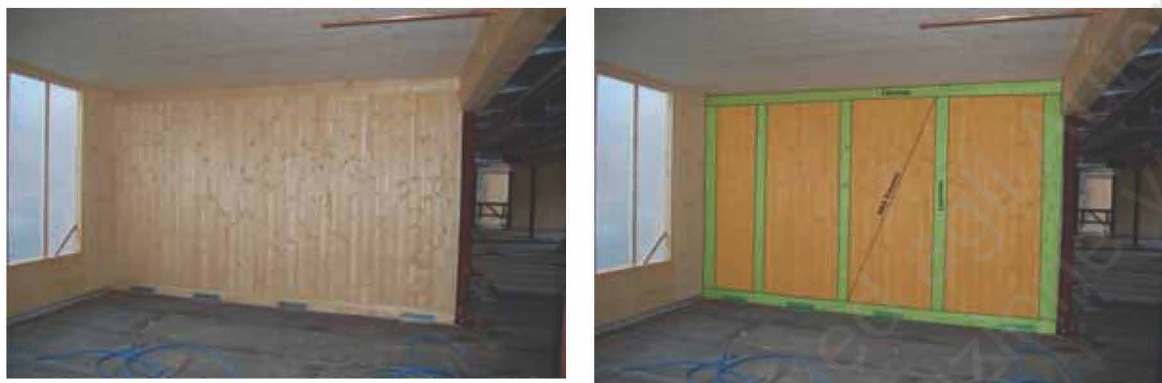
Collegamento parete-parete verticale (Binder BBS)
